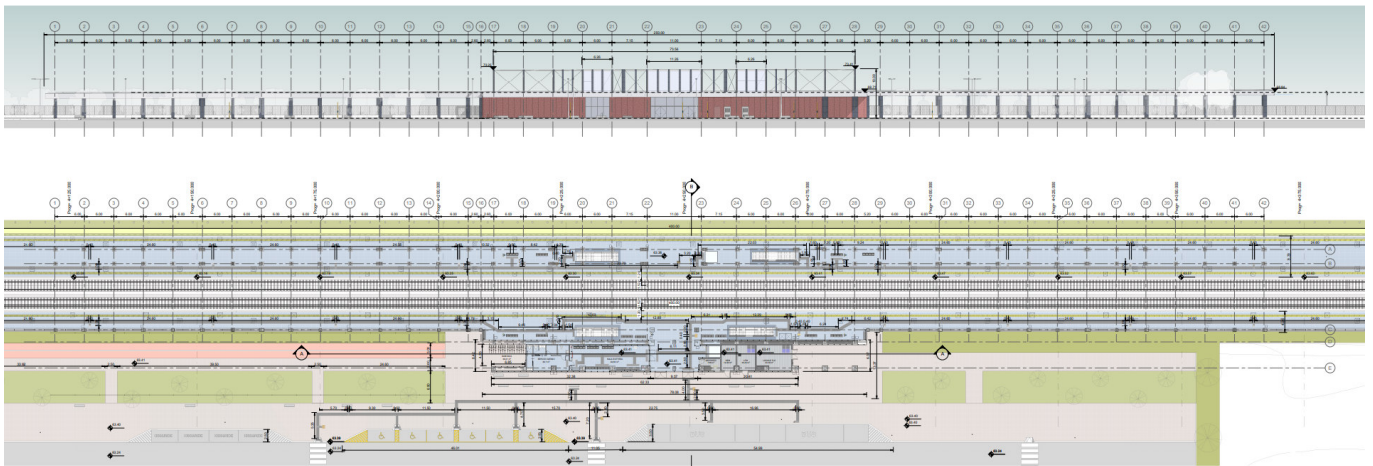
Vista Planimetrica della nuova Fermata AV di Foggia
